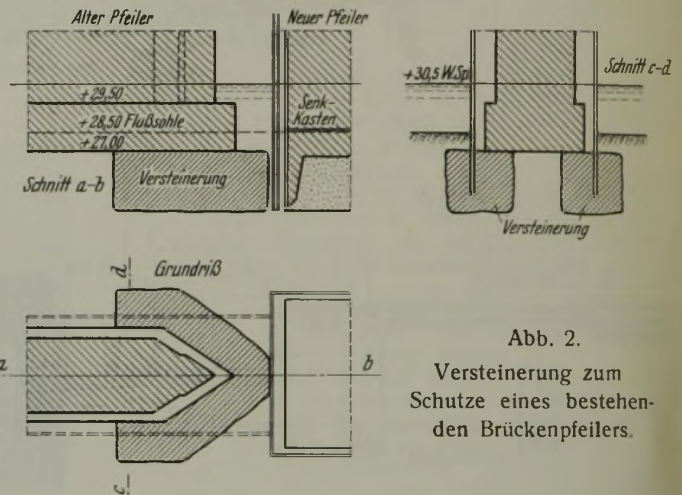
Versteinerung zum Schutze eines bestehenden Brückenpfeilers.
